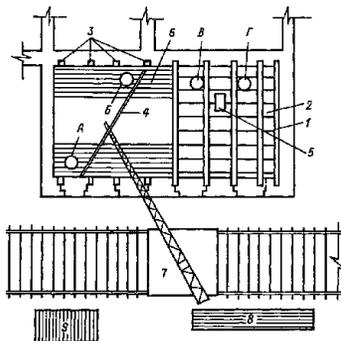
Схема организации работ на захватке по монтажу перекрытия из железобетонных тавровых балок с плитами заполнения:
